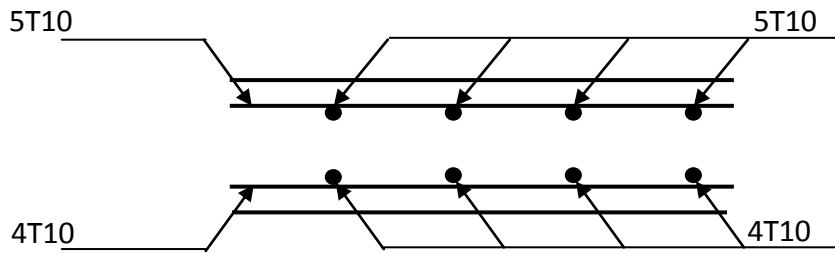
Vue en coupe du ferrailage de la dalle.
